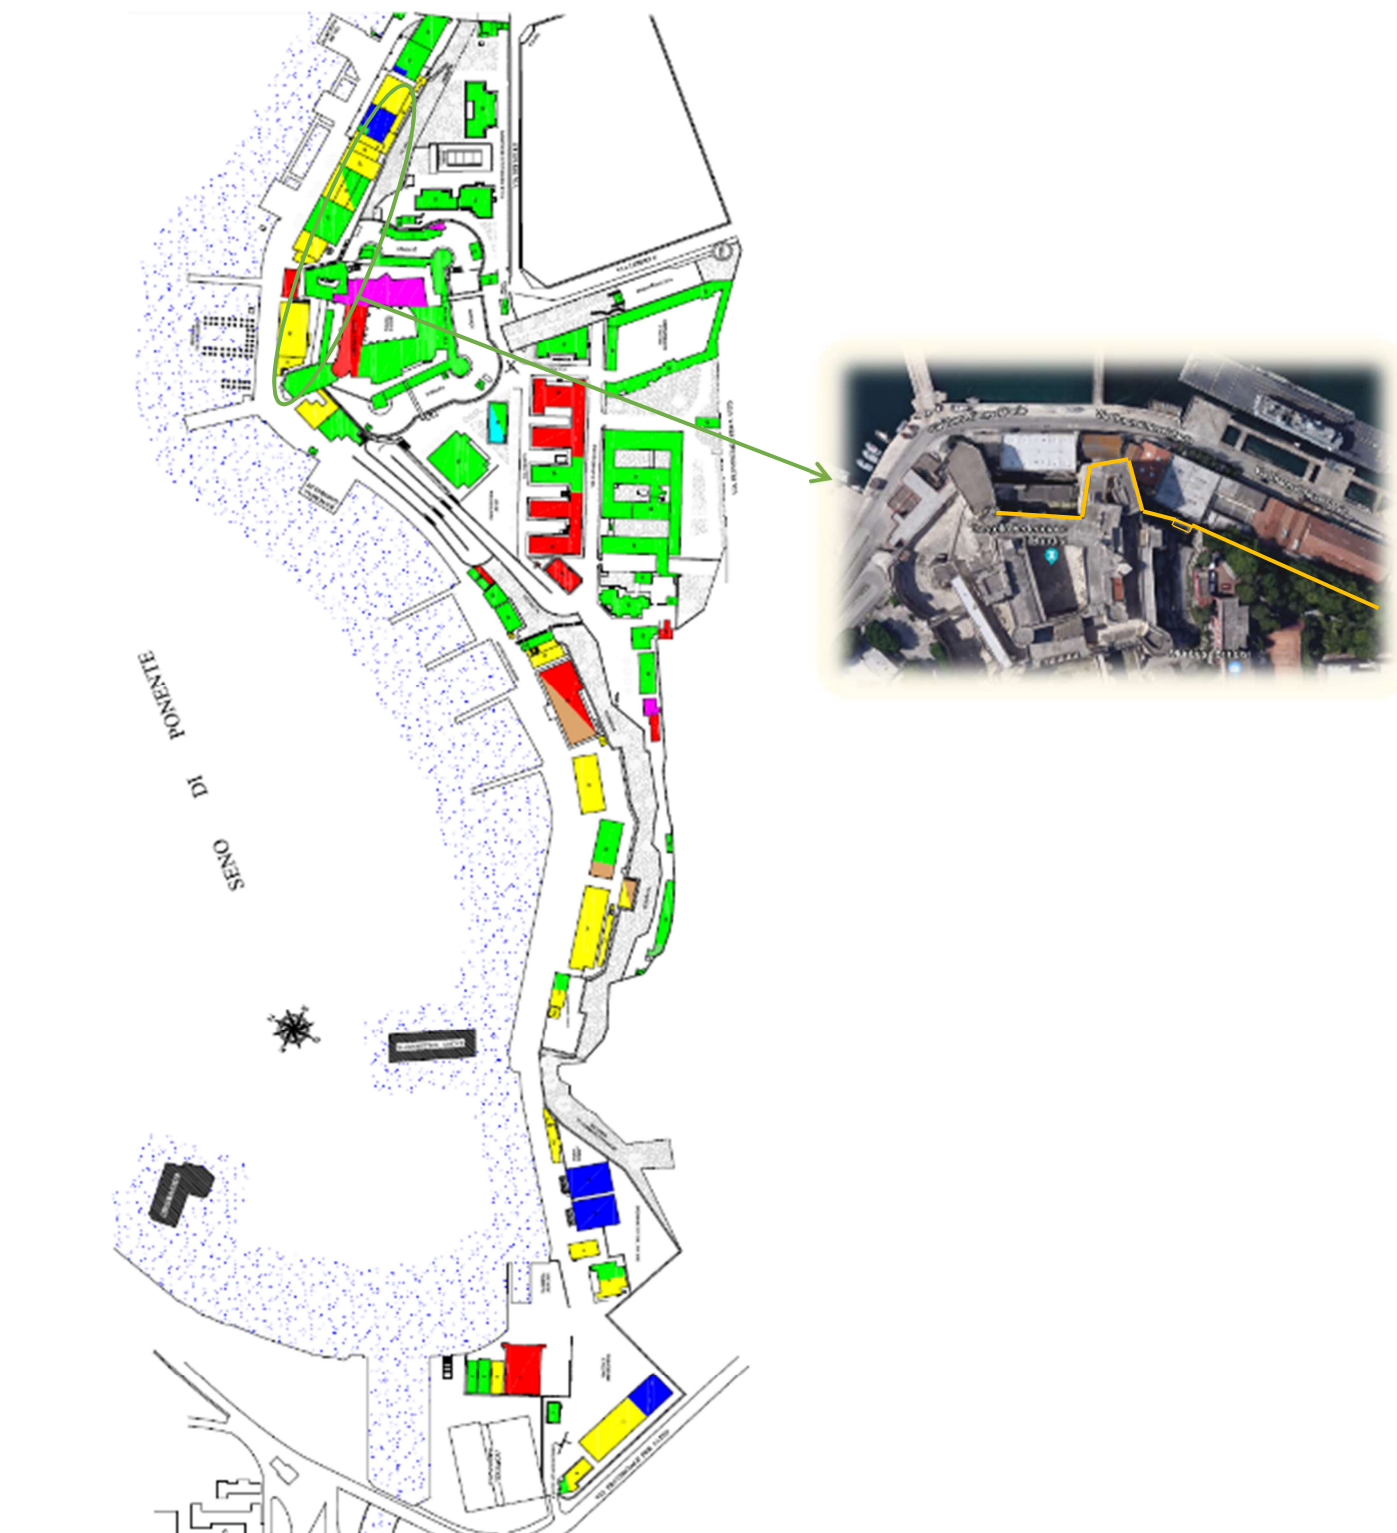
Planimetria generale del Co.Di. con indicazione delle zone oggetto di intervento
